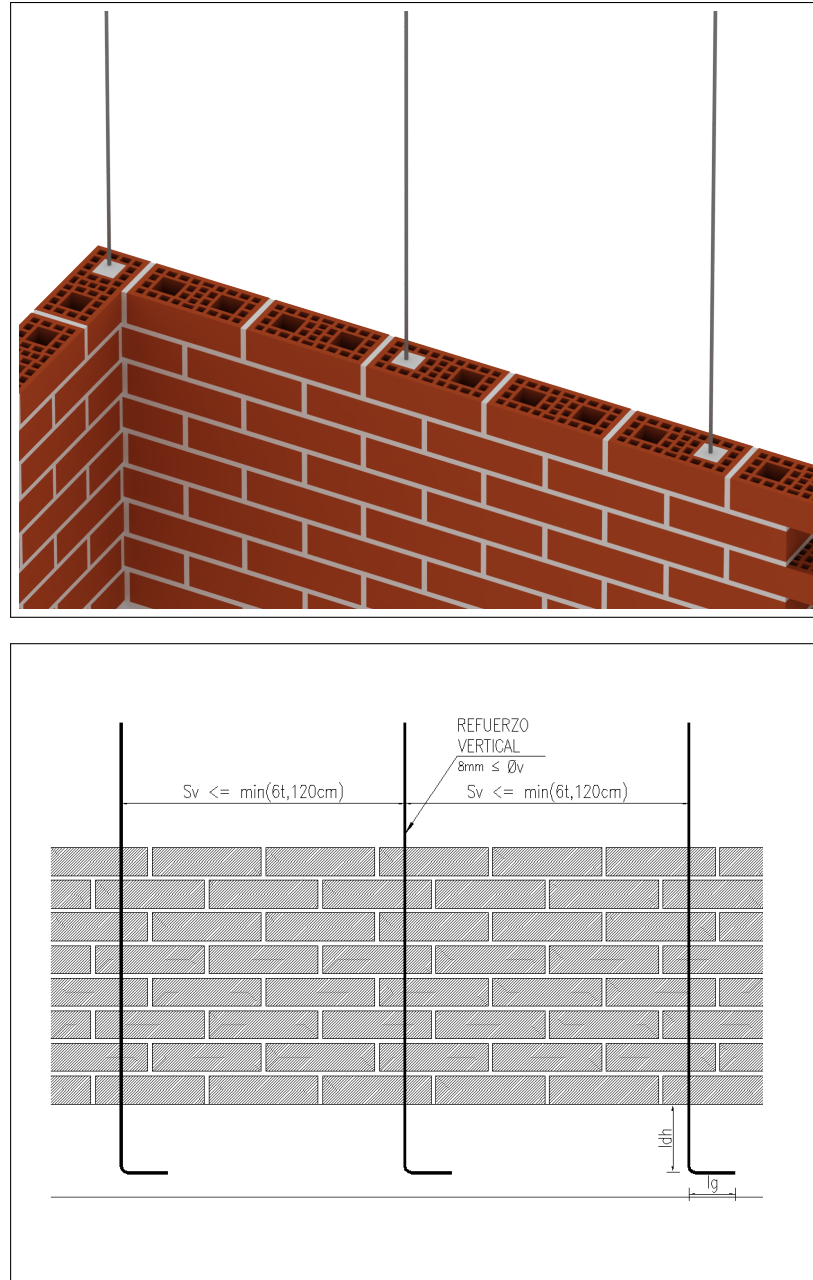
Distribución de las barras de refuerzo vertical a lo largo de un paño de albañilería.
